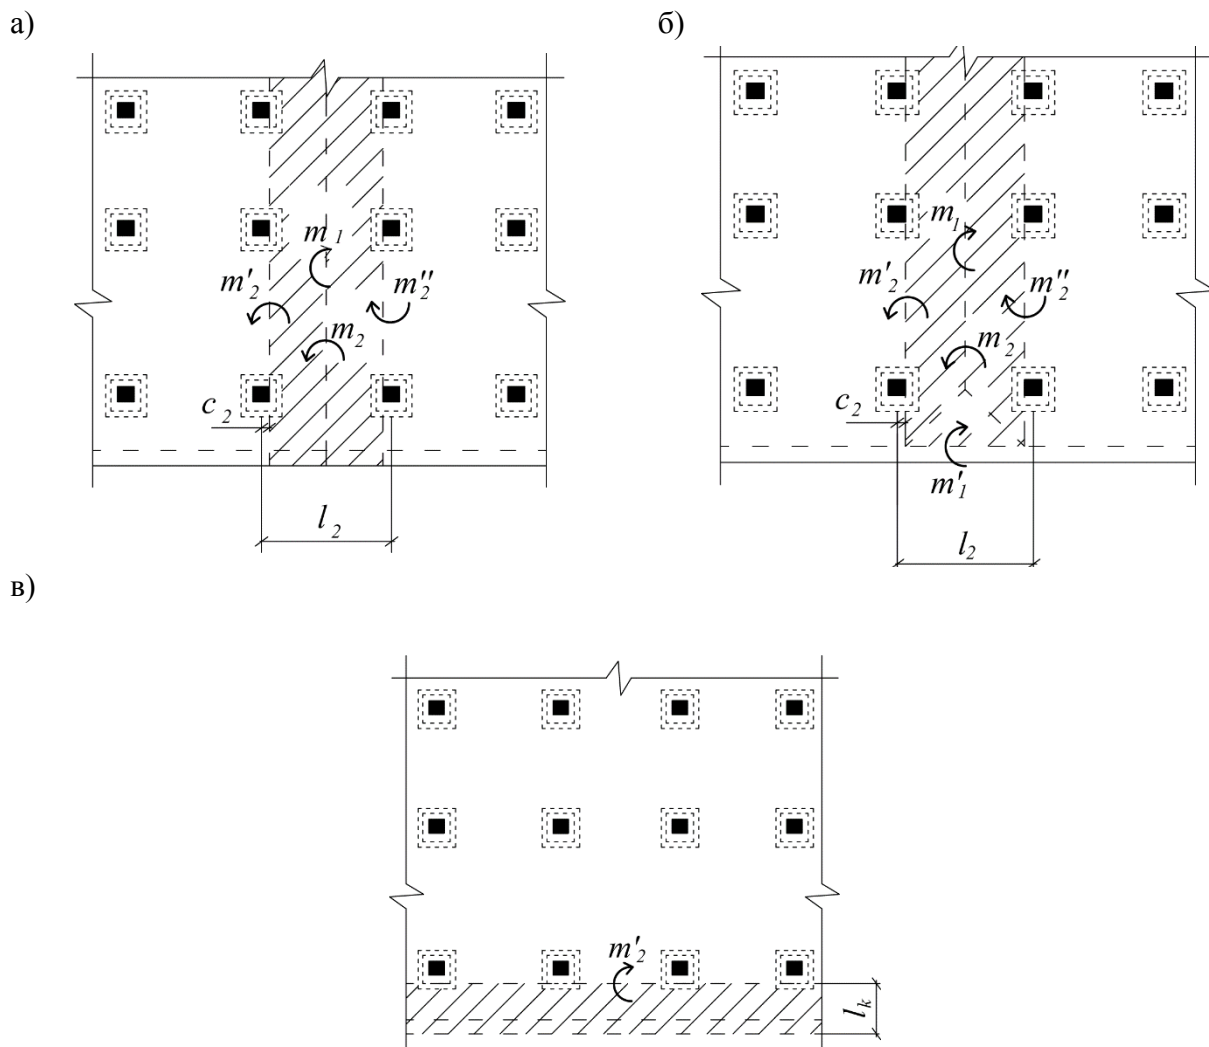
Расчетные схемы крайних панелей безбалочного перекрытия с ребром жесткости
